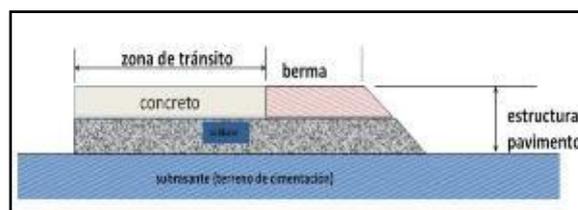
Estructura del pavimento rígido. Extraído de "Tópicos de Pavimentos de Concreto- Diseño, construcción y supervisión", elaborado por Salas ⁽¹¹⁾
